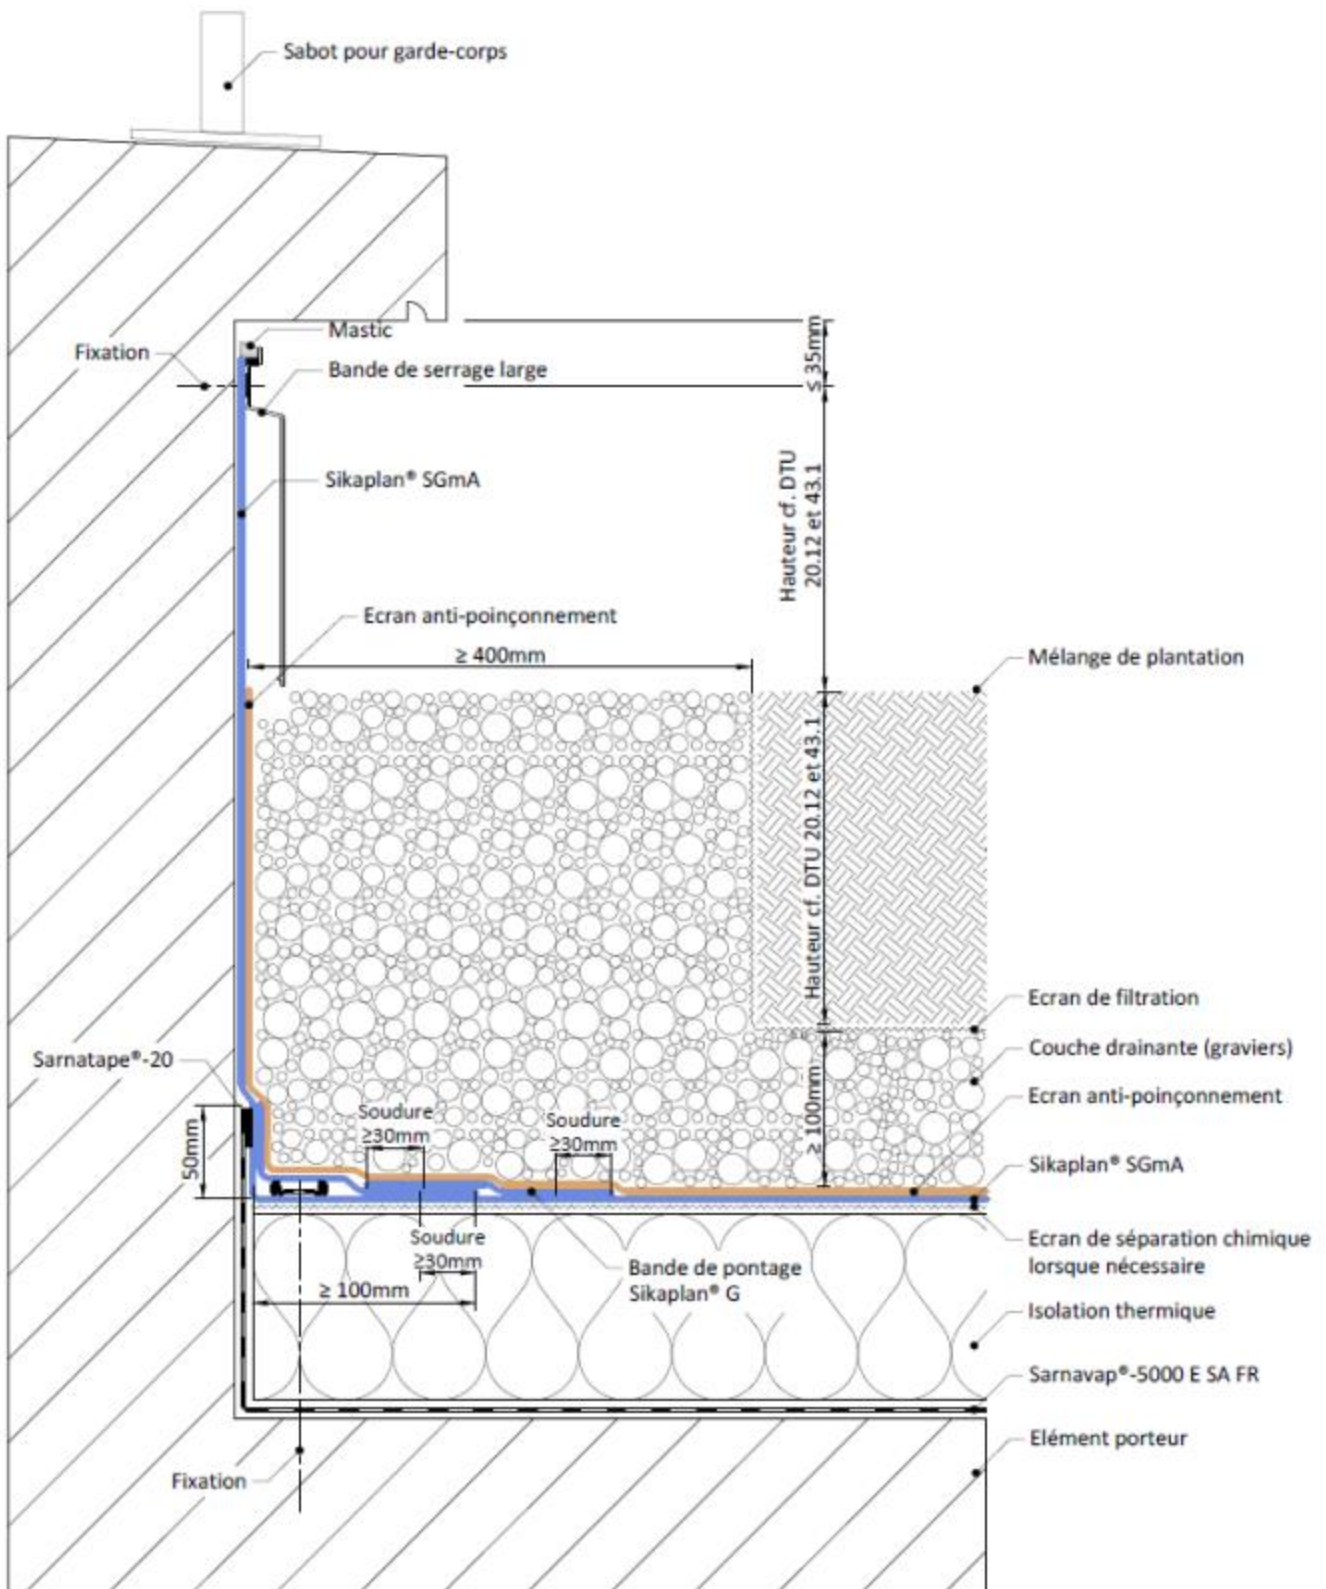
Relevé d'étanchéité sous bande soline avec zone stérile – Travaux neufs sur maçonnerie avec parement « à l'état lissé » au sens du NF DTU 21
